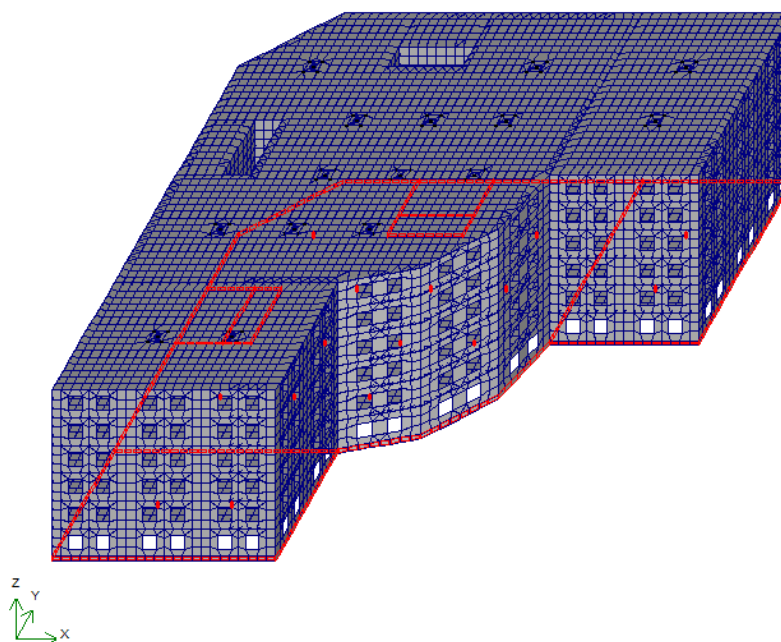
Схема расположения стен первого, цокольного этажа
